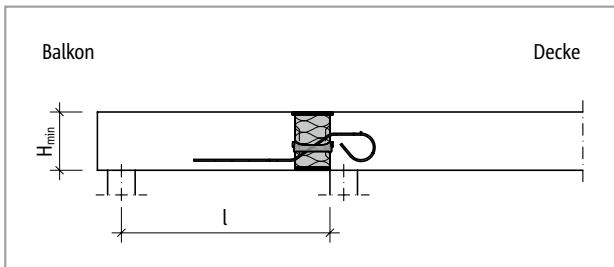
Schöck Isokorb® XT Typ Q: Statisches System (XT Typ Q-V1 bis V4)
